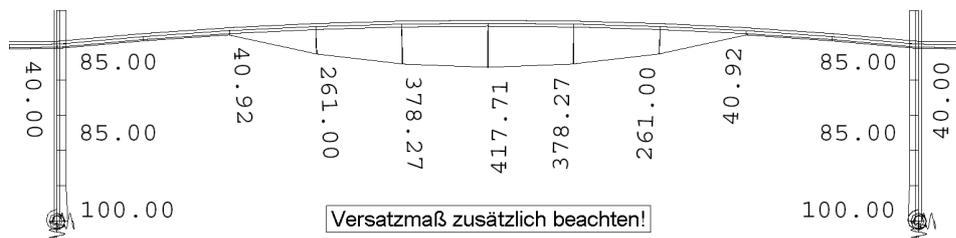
erforderliche Bewehrung zur Begrenzung der Rissbreite, Rang 1 („unten“ bzw. innen)
